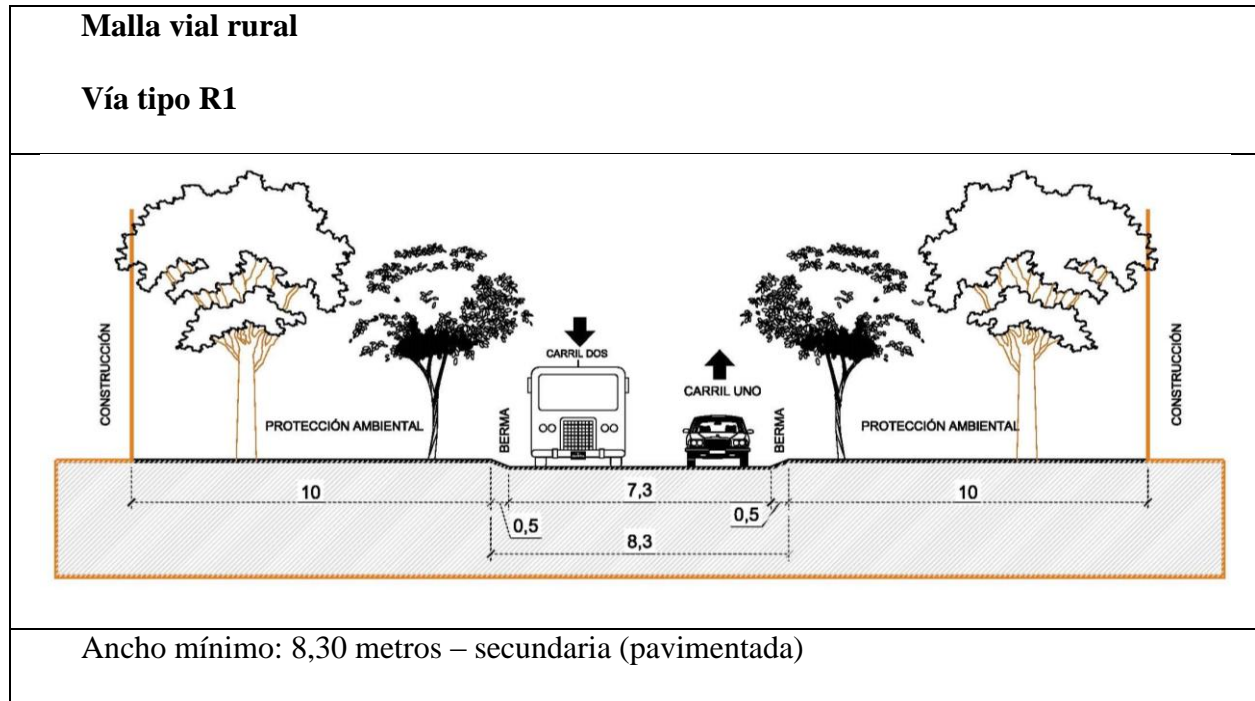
Perfil vial tipo R1. Fuente: POT Barrancabermeja.
